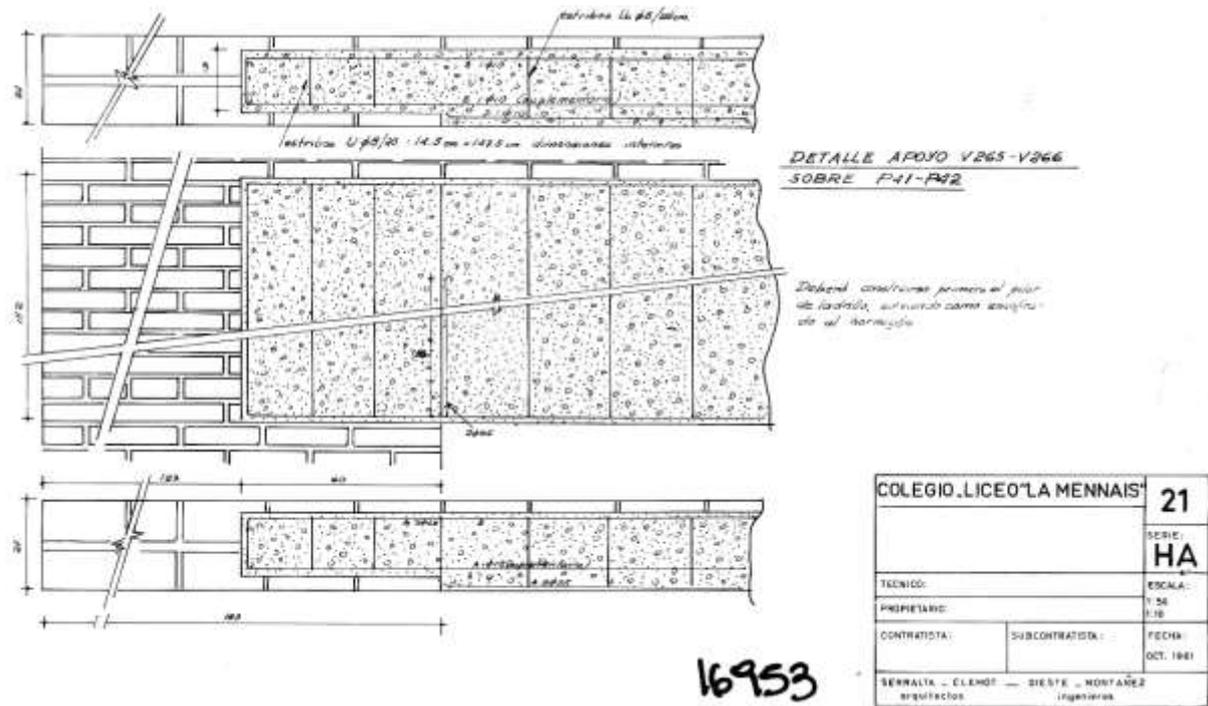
/ Sector del Plano 21 Serie HA, 1961 / DDI-IH-FADU N°16.953
